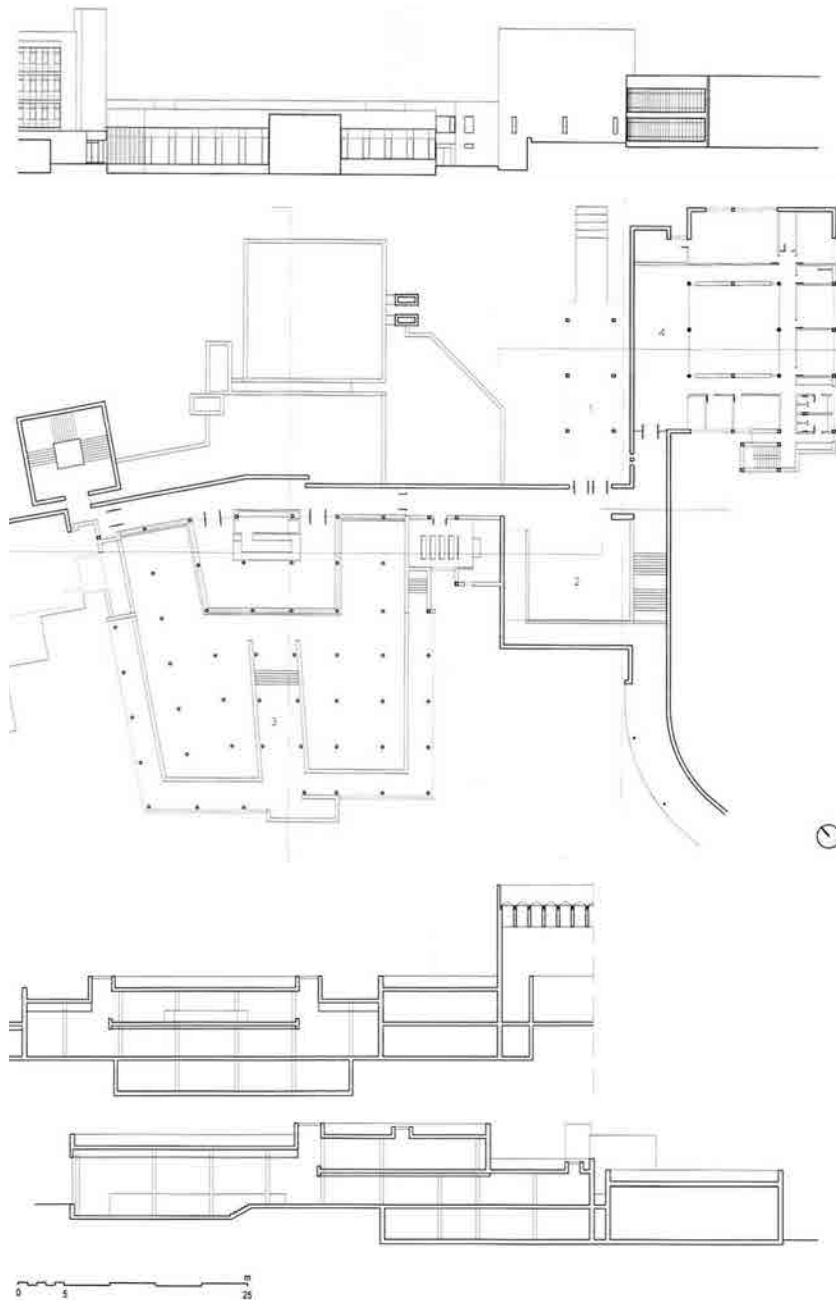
, Fig. 21, Fig. 22 y Fig. 23 Zona de comedor-cocina y cafetería, junto a la zona de acceso, vestíbulo y dirección. De arriba a abajo: alzado de la fachada Sur, planta (con la cafetería en el altílo y la cocina bajo ésta), sección frontal al comedor y sección transversal por el comedor.
